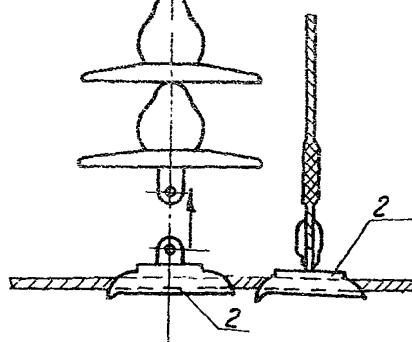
Узел „А“ Крепление монтажной лестницы и монтажного блока на траперссе при перекладке проводов
